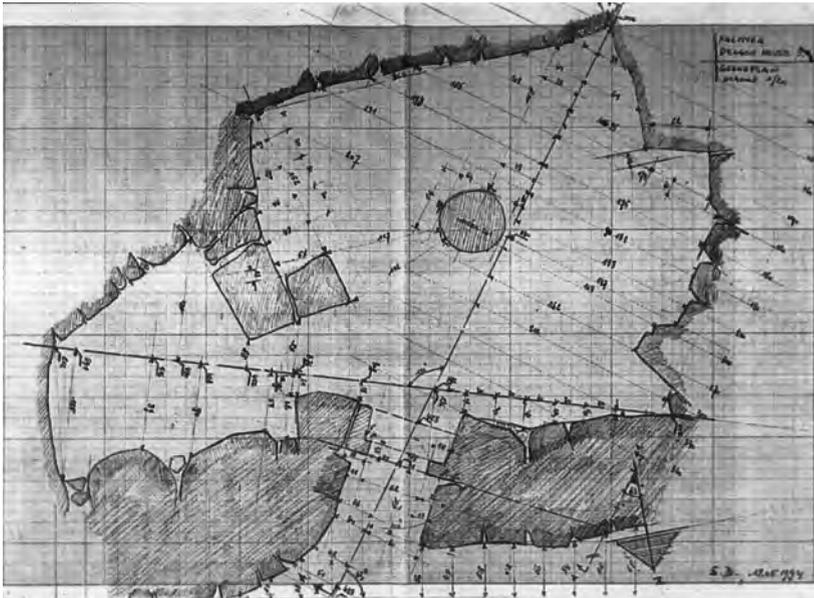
Palmyra, Steinbruch 3, Drachenhaus 3.1, Plan (P. Deneef)
